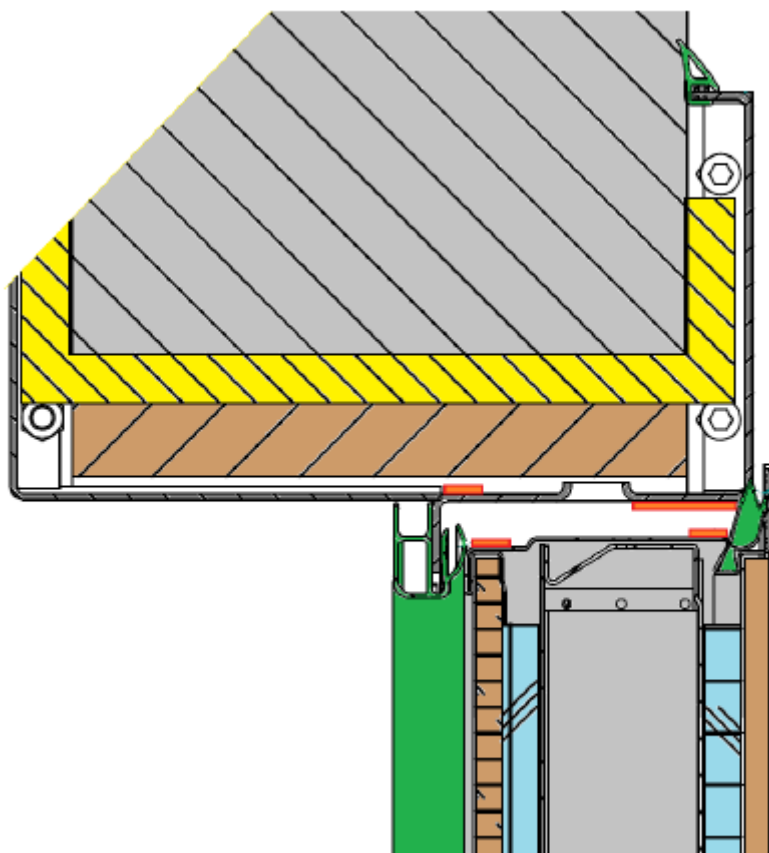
detail schuimvormers t.p.v. de bovenregel
